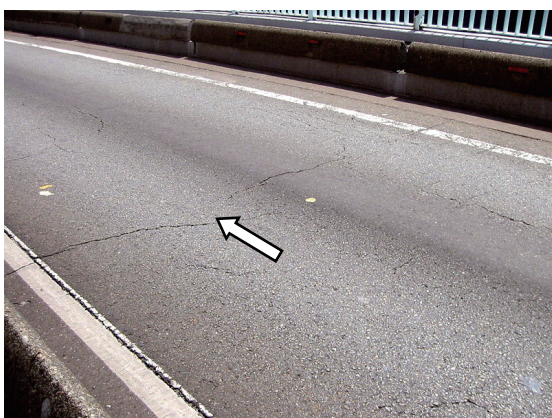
横断方向の舗装ひび割れ
